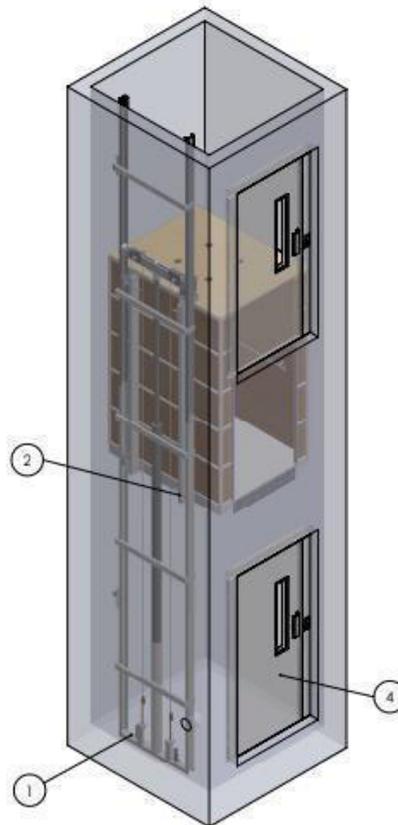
Diseño elevador de dos plantas con puertas manuales
